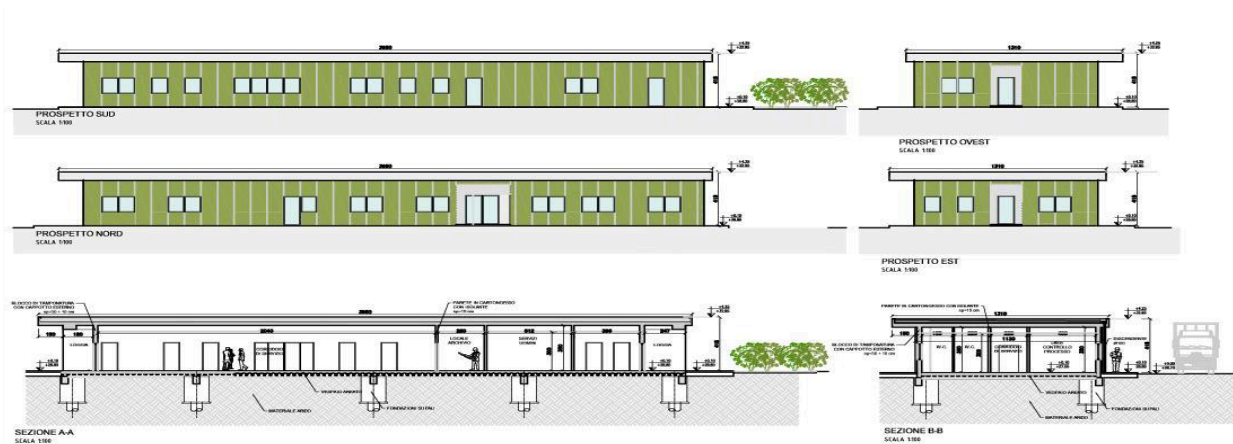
Prospetti e sezioni edificio uffici/servizi addetti
